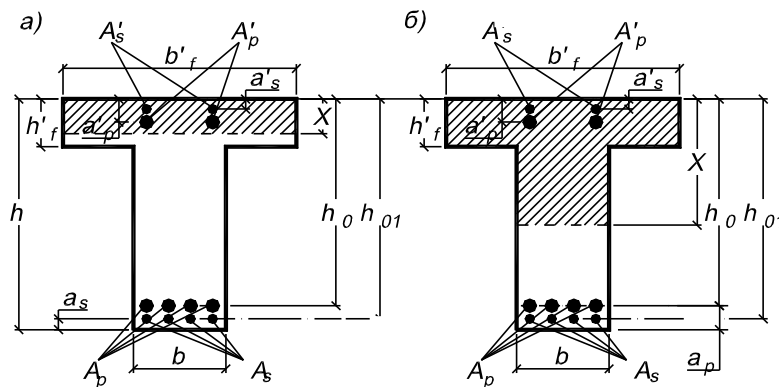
Форма сжатой зоны в сечениях железобетонных элементов с плитой в сжатой зоне
